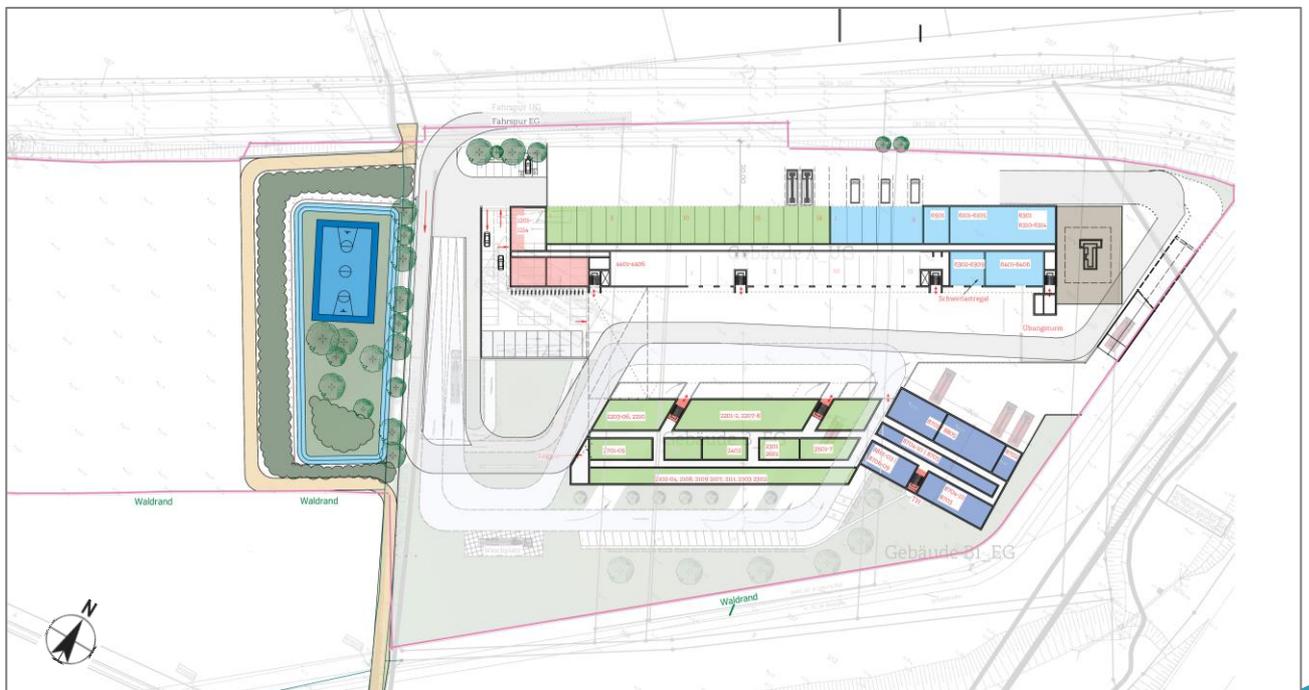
Ausschnitt Grundriss EG [19], zu untersuchender Standort der geplanten FRW Nord „Auf den Heunen“, Leverkusen (vgl. Fließtext), unmaßstäblich
